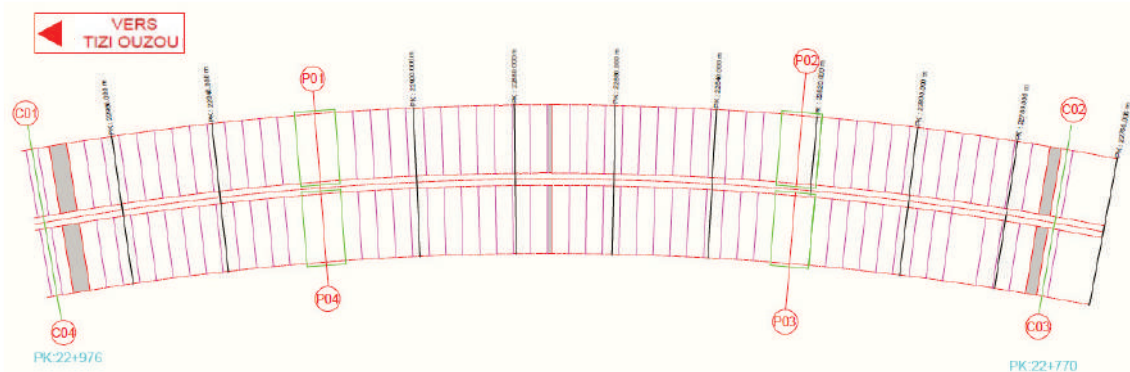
vue en plan de la variante (03) « Pont vousoir ».
